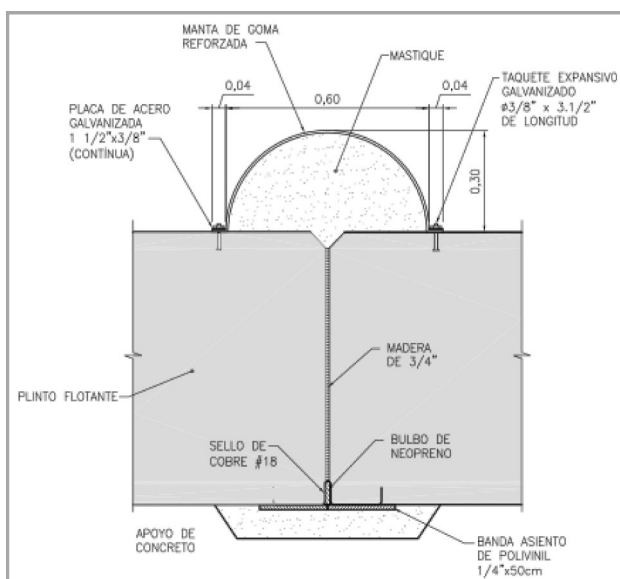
Detalle de juntas en plinto articulado (presa Chaglla, diseño base)
